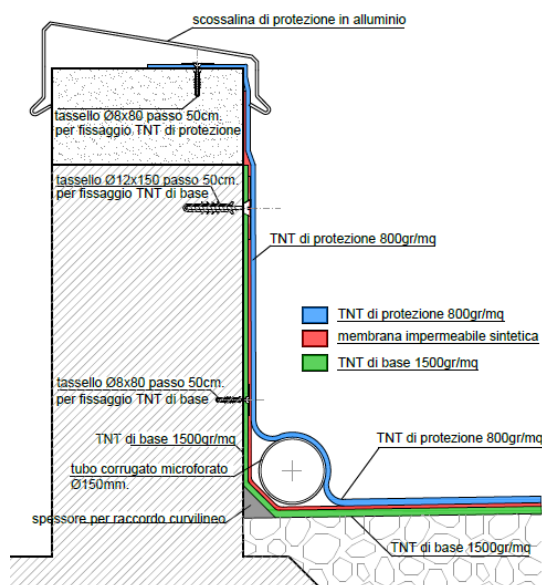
Posa del TNT di protezione (strato di colore azzurro) del peso di 800 gr/mq sul parapetto/timpano
